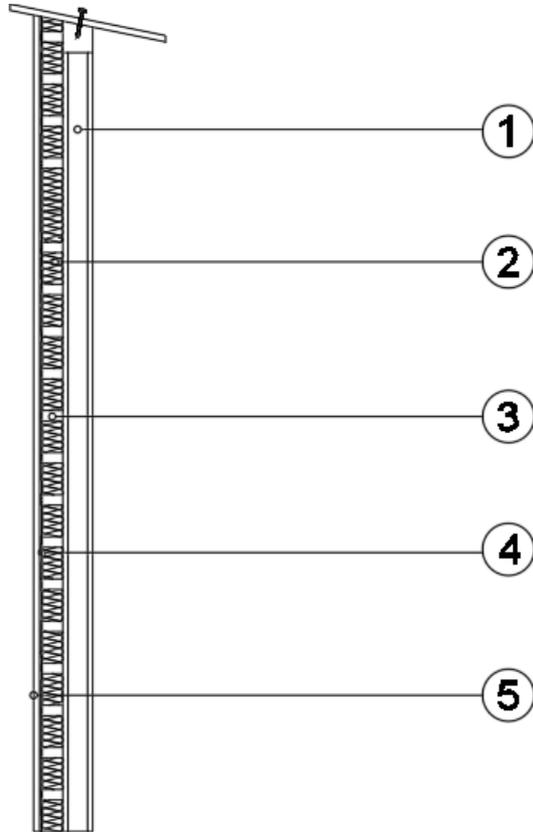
Detalle constructivo tabique divisorio de aluminio estado actual
